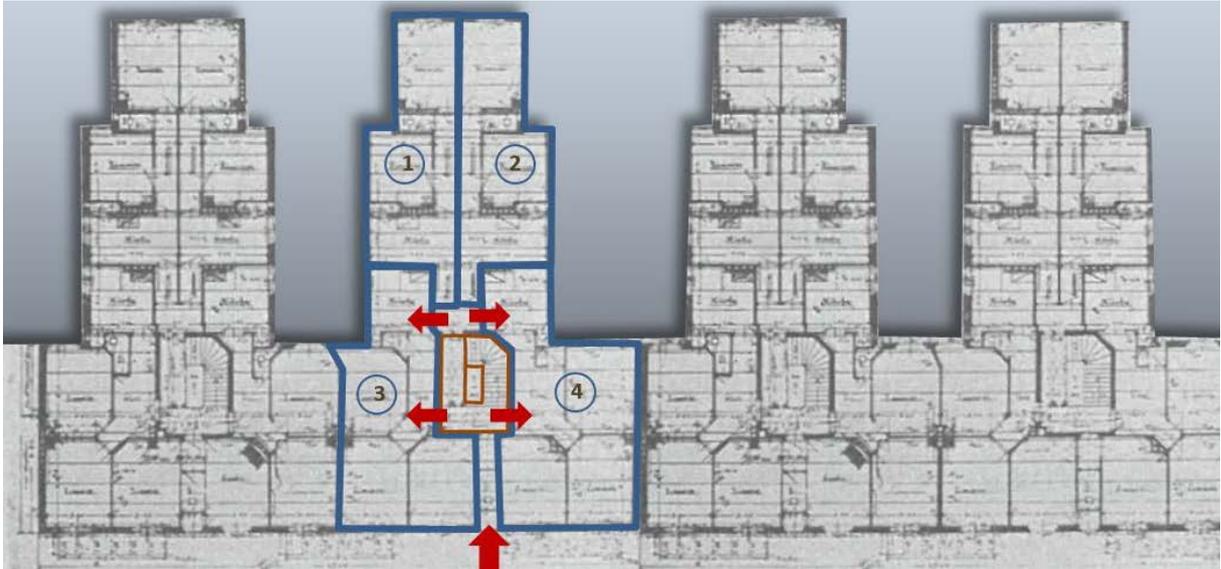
Aneinanderreihung von sogenannten Vierspännern mit jeweils vier Wohnungen pro Etage (Ergänzungen auf Grundriss aus Schumacher: 1932, S. 29)
